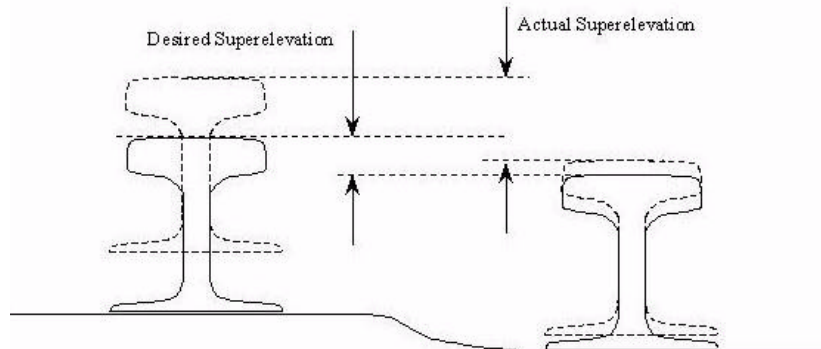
Sopraelevazione (*superelevation*) del binario
